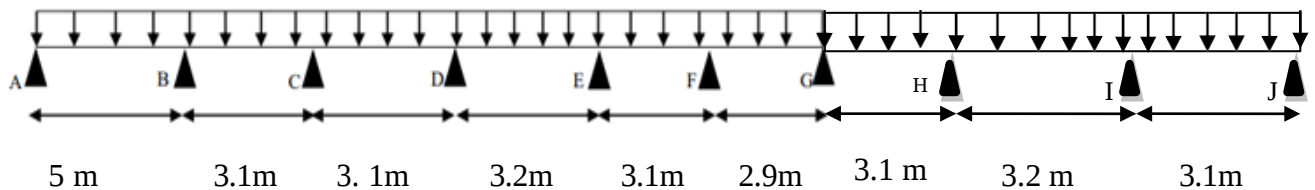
Schéma statique de la poutrelle à 9 travées.
